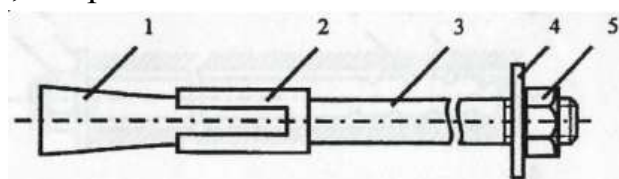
Конструкция металлического клинораспорного анкера с двухперой гильзой
